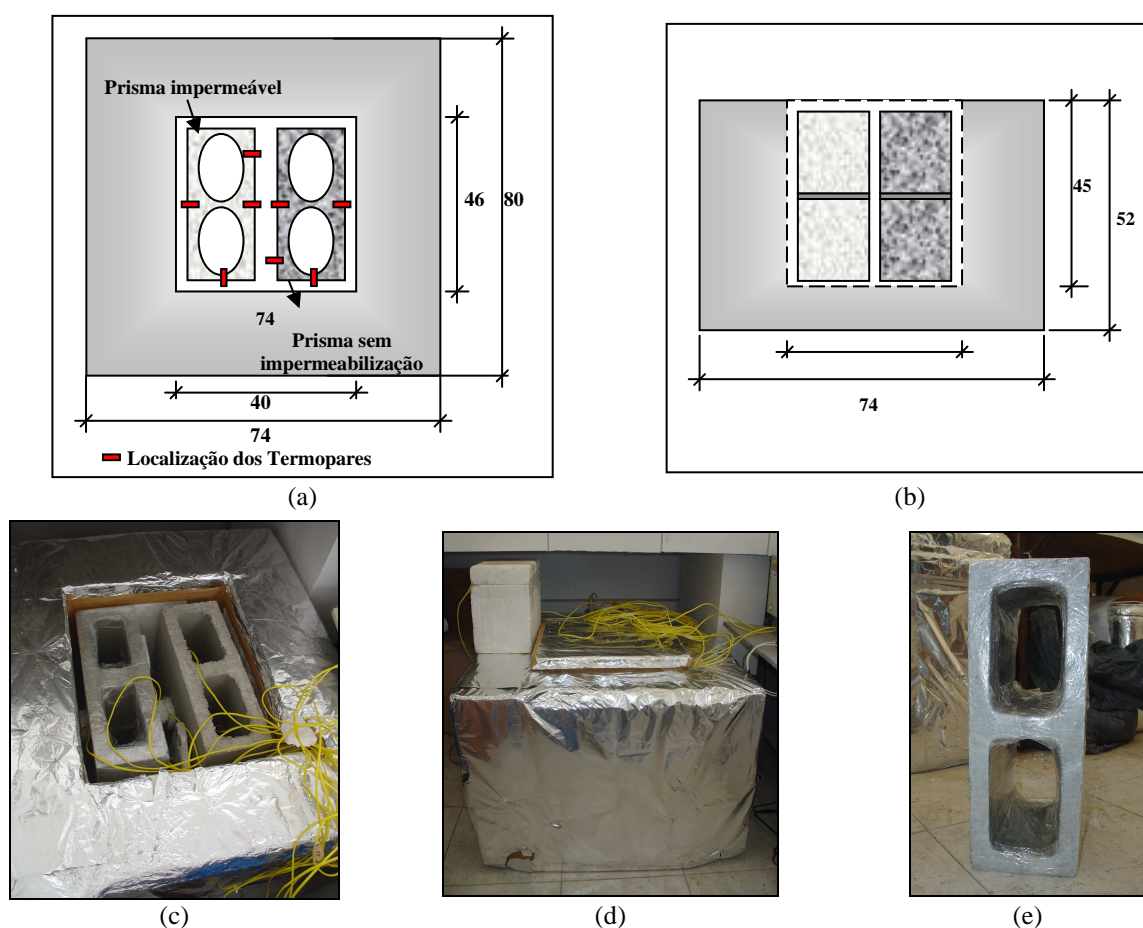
Ensaio de início de pega das juntas de assentamento: (a) dimensões da vista superior de calorímetro e localização dos termopares, (b) dimensões da vista frontal do calorímetro, (c) ensaio pronto para iniciar, (d) configuração final do ensaio e (e) bloco de concreto revestido com filme de PVC transparente.
